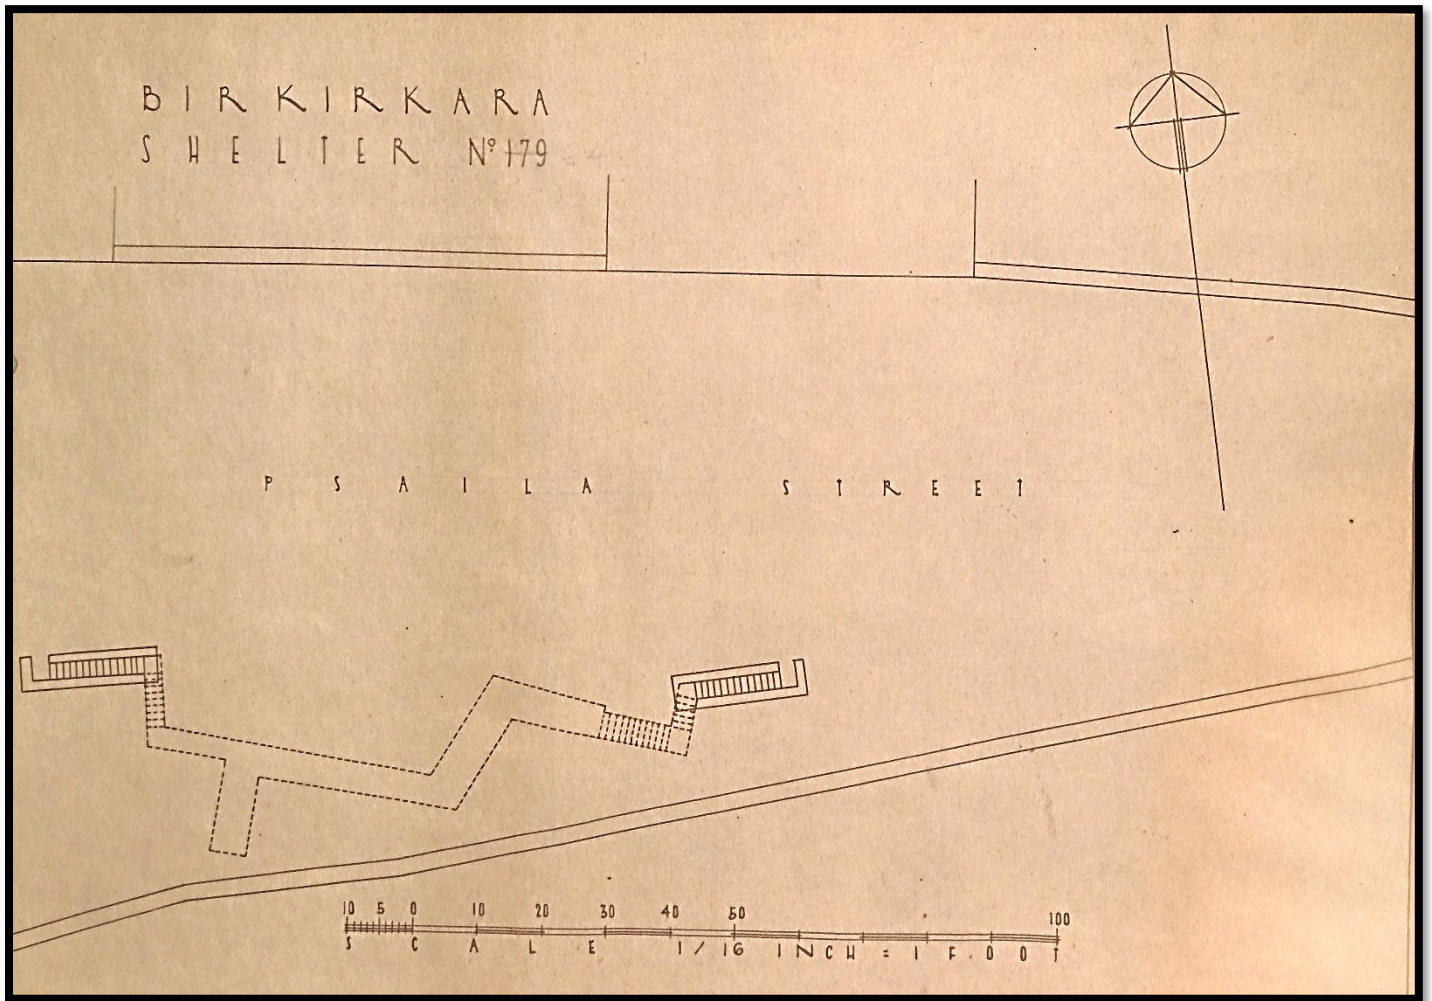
Planta do Abrigo nº 179 (24) "Psaila Street"
